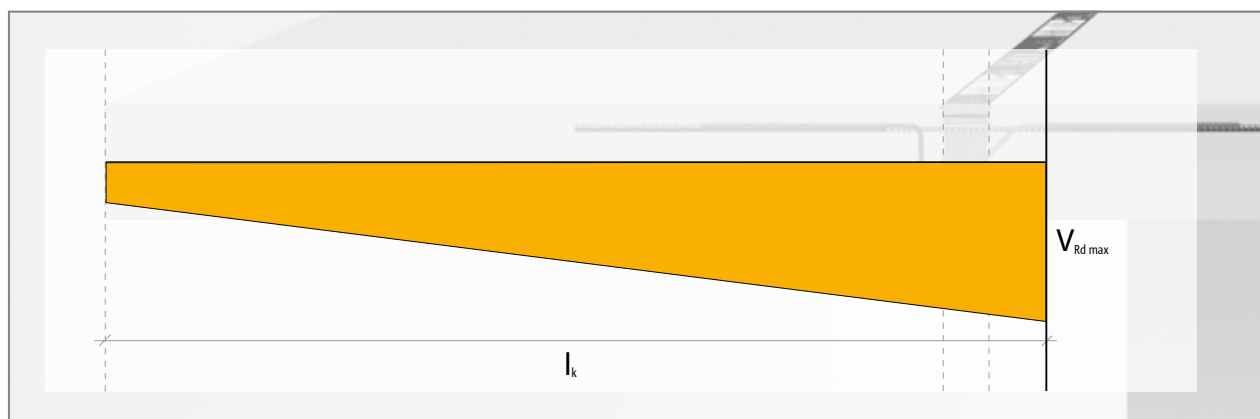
Schöck Isokorb® T tip KL: projektne obremenitve
